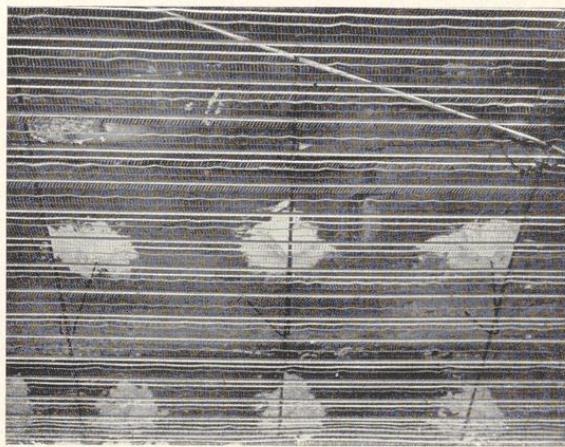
Rippenstreckmetall als Bewehrung für Rabitzdecke unter Massivdecke
